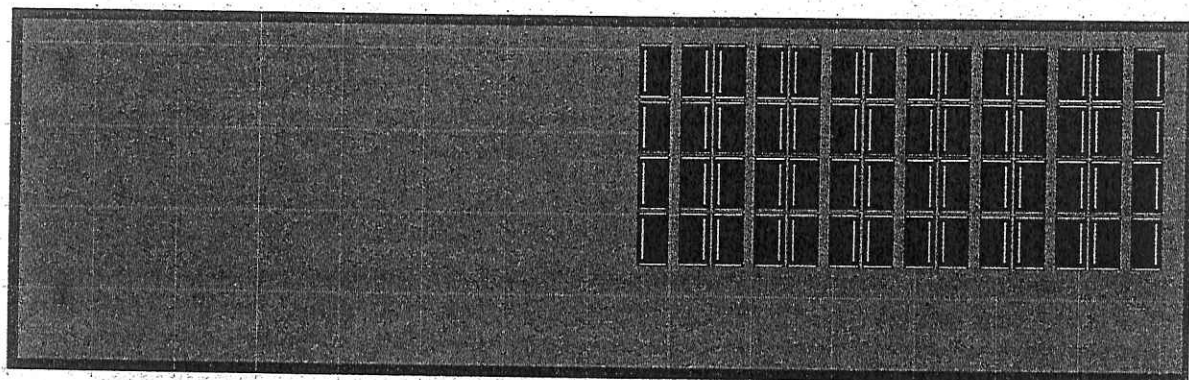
Wizualizacja dachowej instalacji fotowoltaicznej na dachu KM PSP w Tychach
